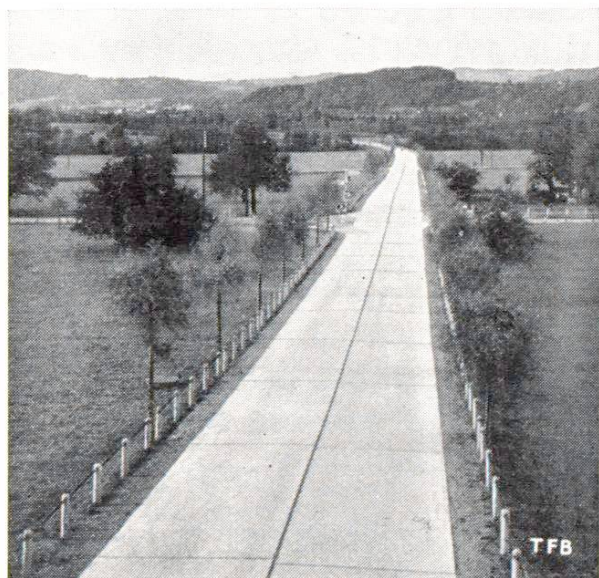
Clôture d'une route au moyen de poteaux en béton armé. Route cantonale Gossau-Wil.
